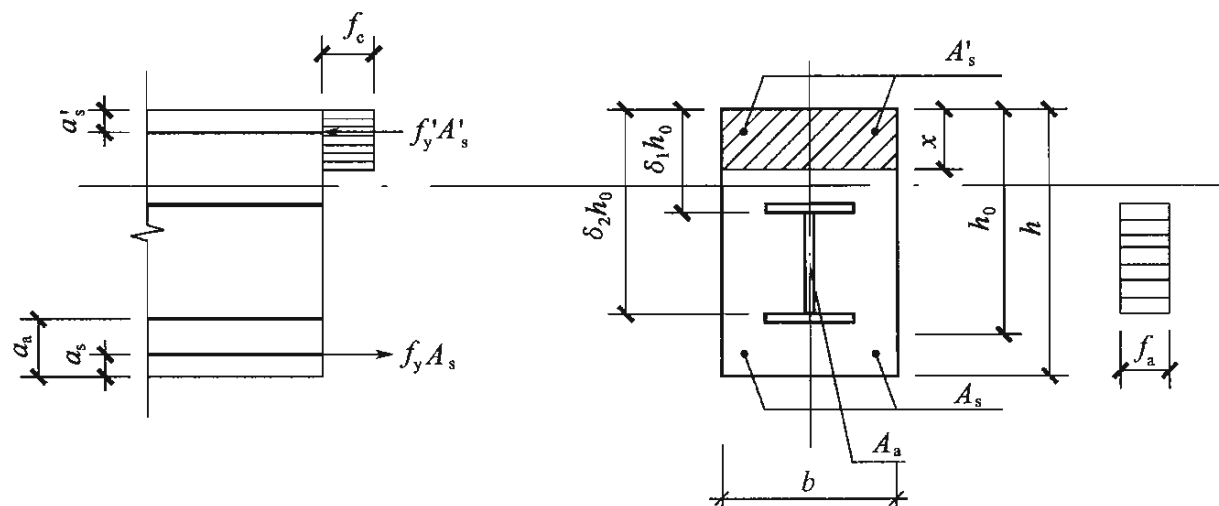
中和轴不经过型钢腹板充满型实腹型钢混凝土梁受弯承载力计算简图
